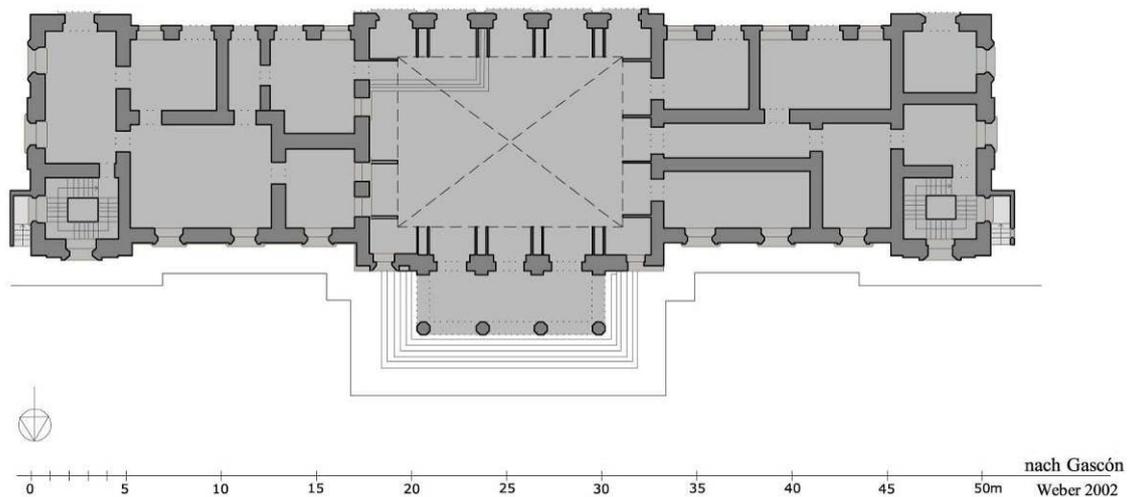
Hedschasbahnhof [44], Grundriss EG
